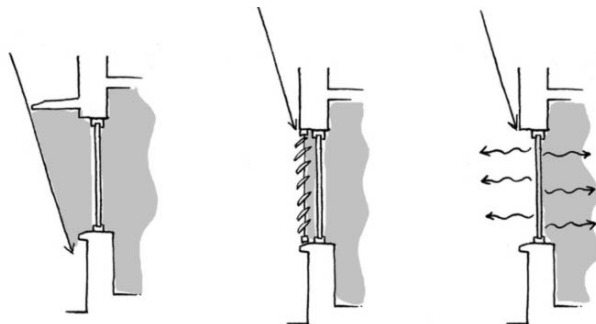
El alero o voladizo horizontal es una protección adecuada para la fachada sur. La protección exterior móvil es muy eficaz para cualquier orientación. Los cristales tintados, en cambio, son una fuente adicional de calor.
